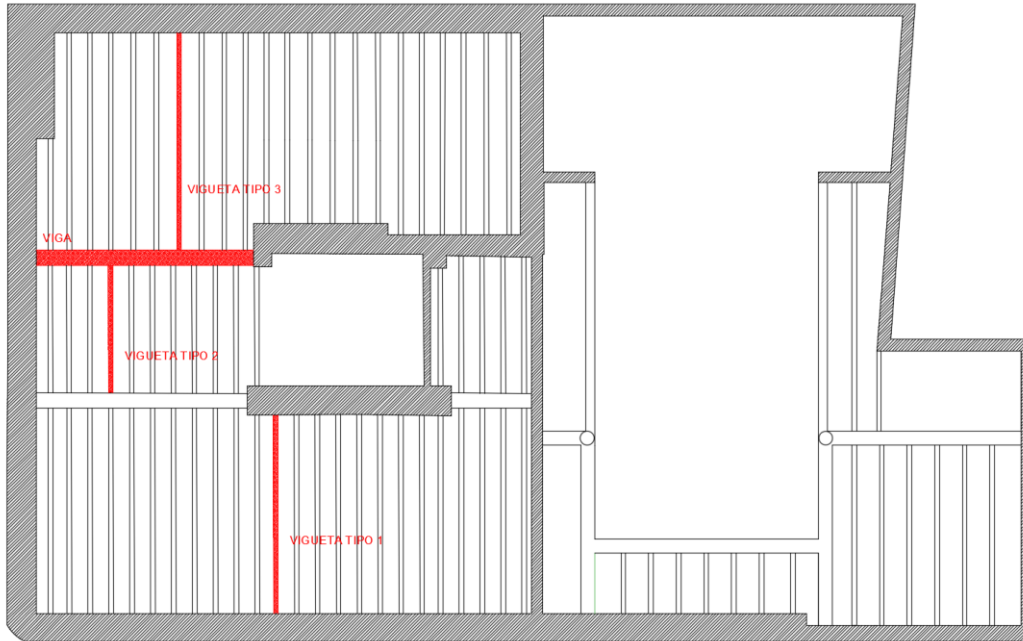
Viga y viguetas a analizar. Fuente: Elaboración propia, creación 01/07/2019
